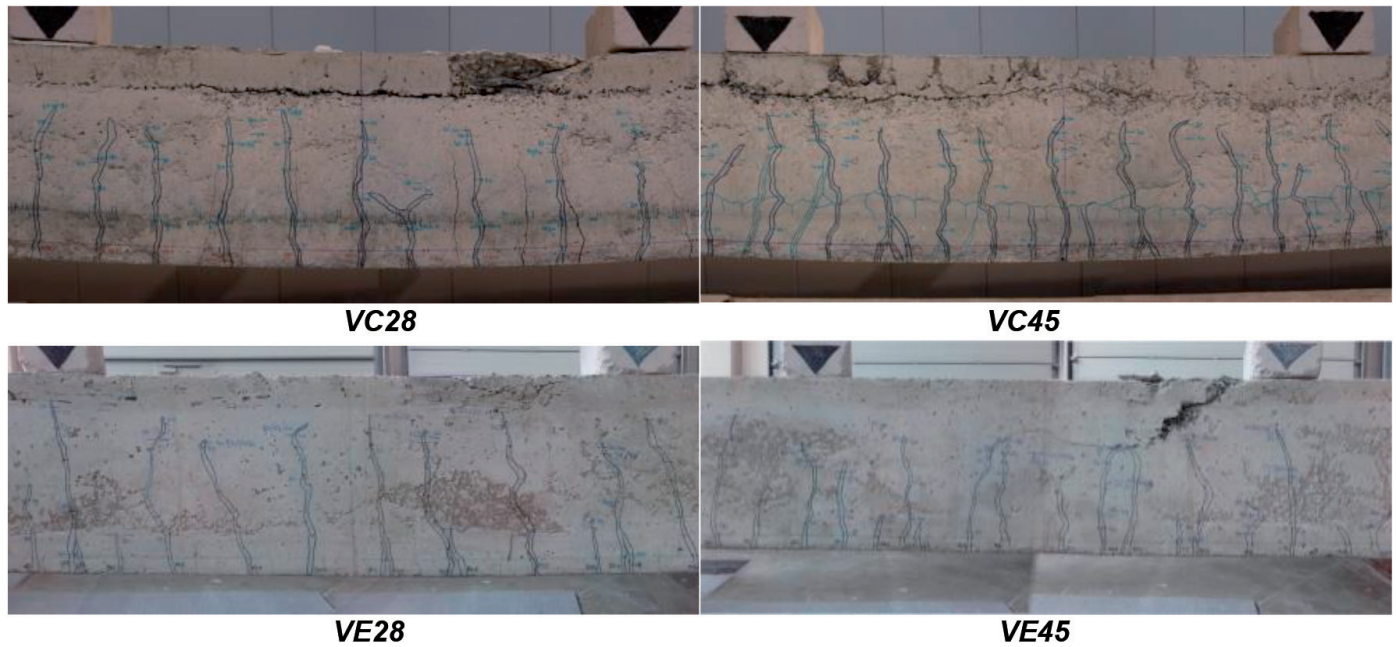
Patrón de fisuración de las vigas en rotura
